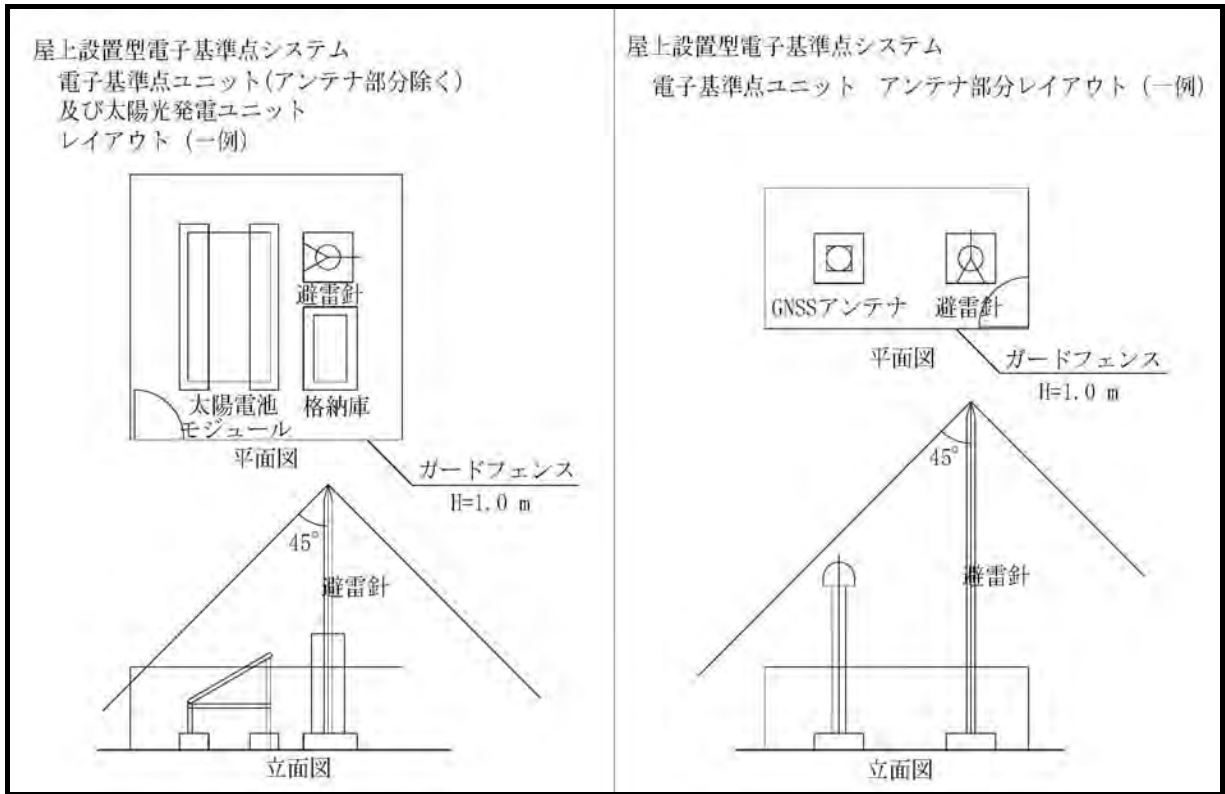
屋上設置型電子基準点システム・機材レイアウト例(平面図・立面図)
